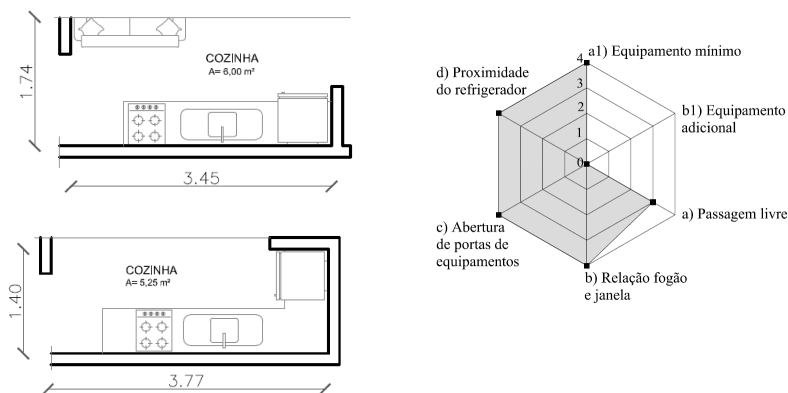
a) Planta baixa cozinha Tipo A. b) Planta baixa cozinha Tipo B. b) Modelo radar da cozinha do Tipo A e Tipo B.
